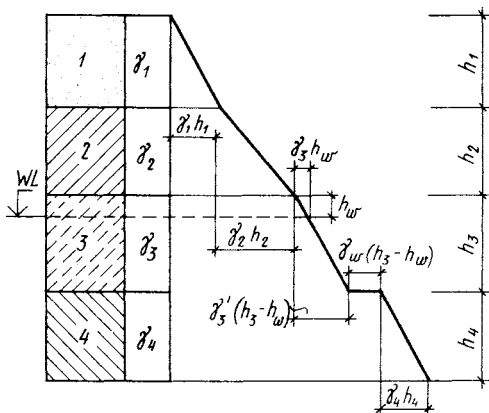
Эпюры напряжений от собственного веса грунта в слоистом основании:
